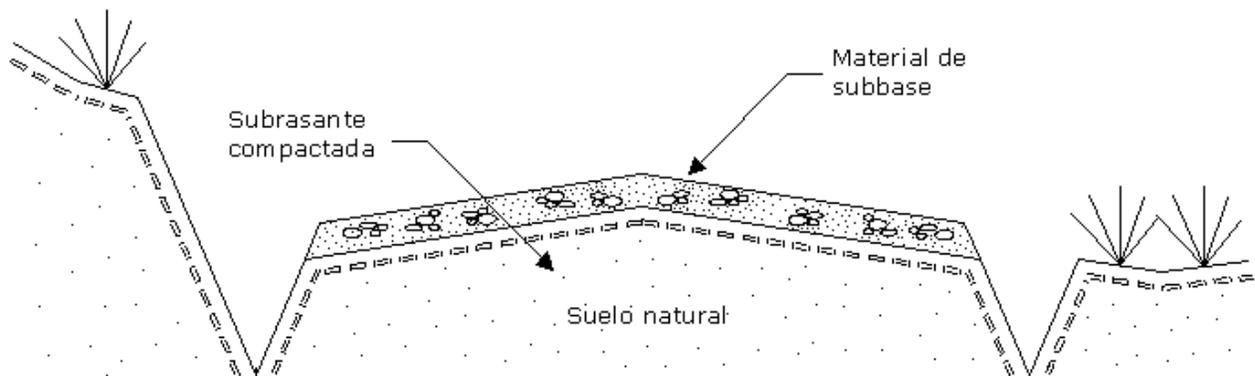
Corte transversal donde se aprecian las capas que conforman un camino de lastre.
